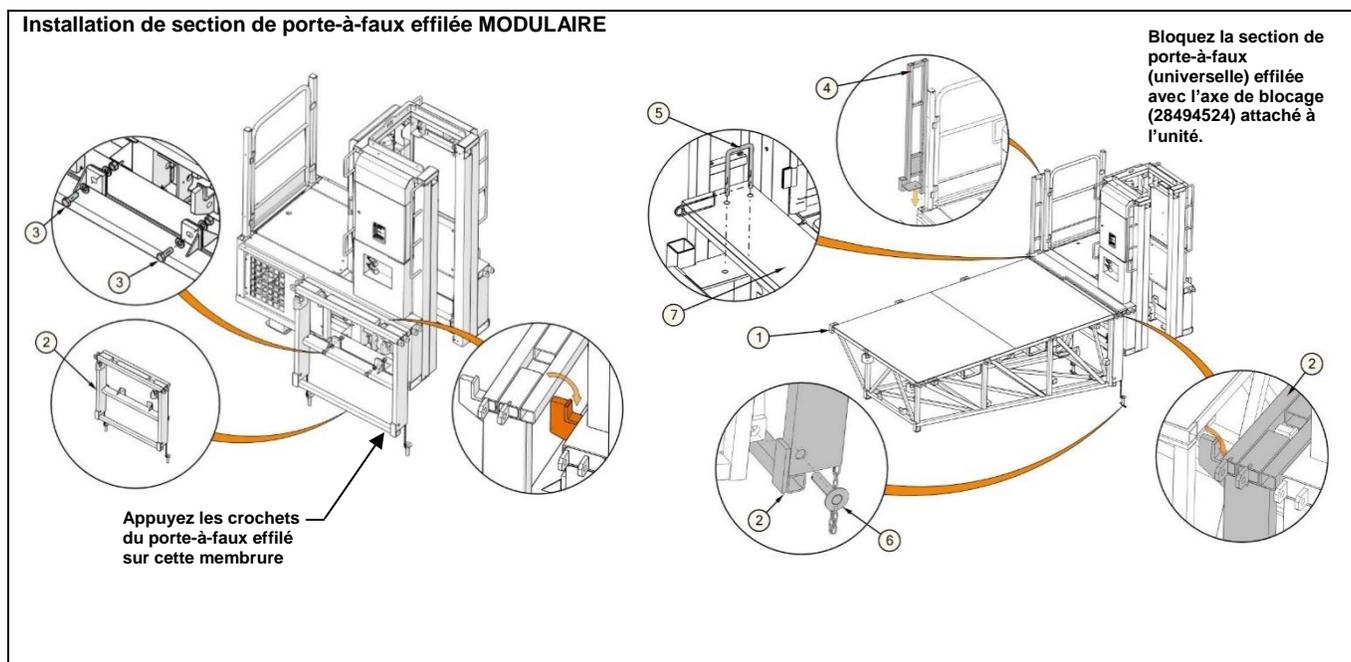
Section de porte-à-faux MODULAIRE effilée
